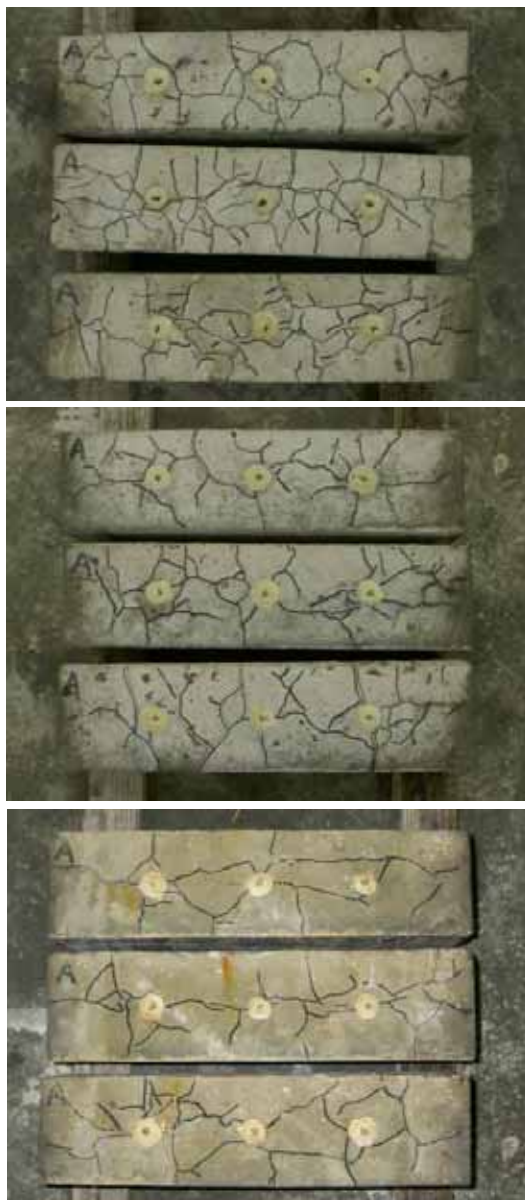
養生施設における暴露試験供試体のひび割れ状況
